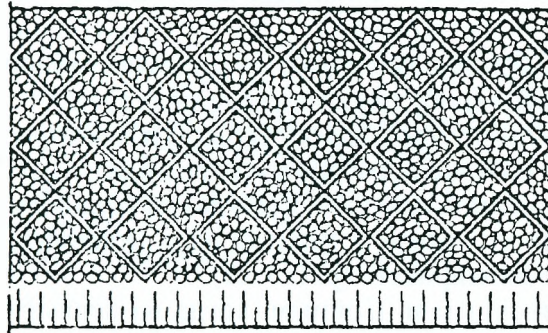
Укрепление откоса каменной наброской в железобетонных ящиках
